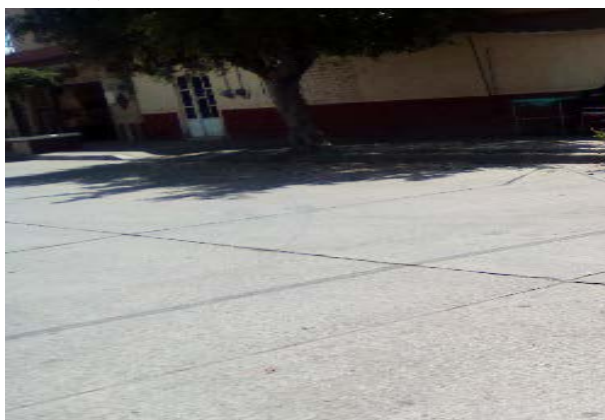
Calle Francisco I. Madero pavimento concreto. Fuente: Propia (2018).
